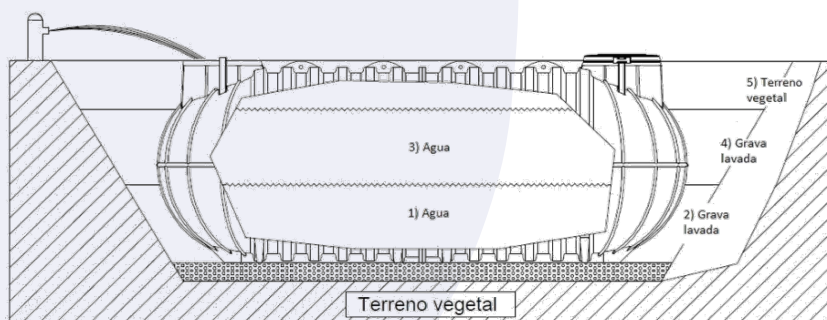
Ilustración II: Capas de relleno a distribuir para el soterramiento del equipo.
